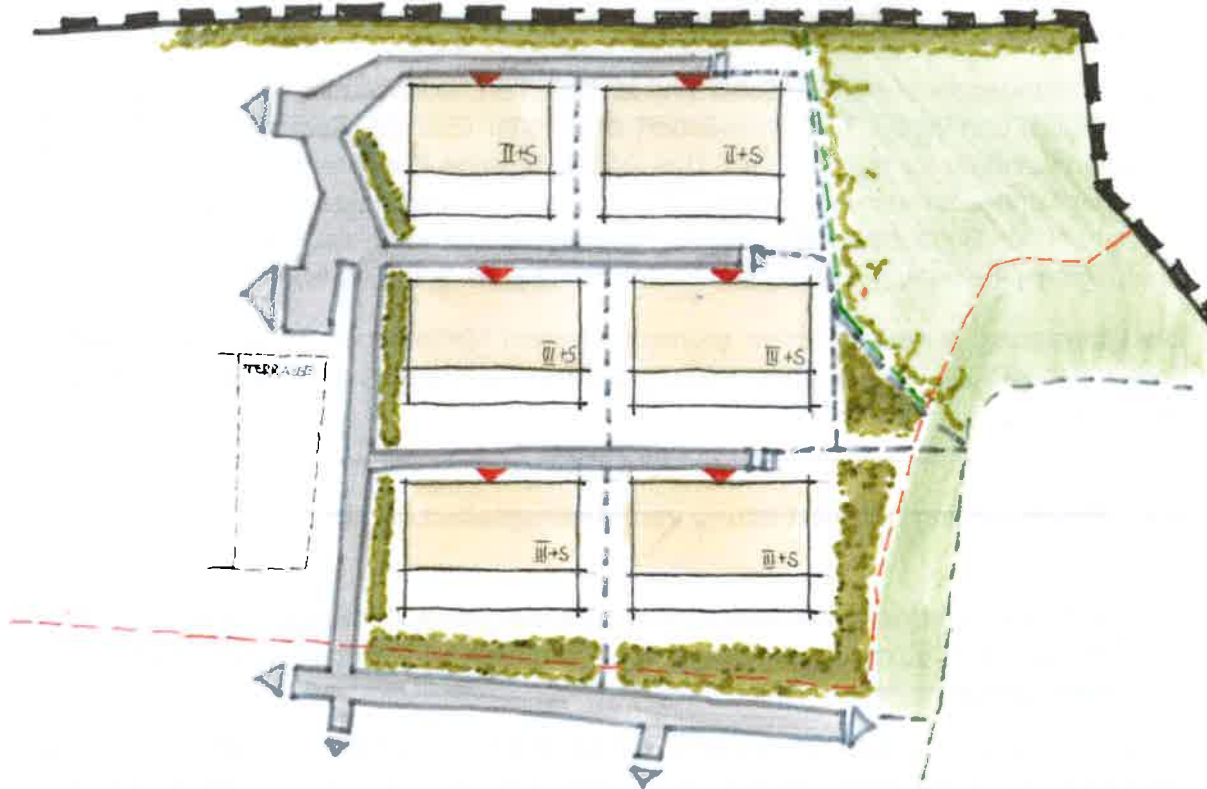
Alternative Bebauung des Teilgebiets „SO2“ (claussen-seggelke stadtplaner)
